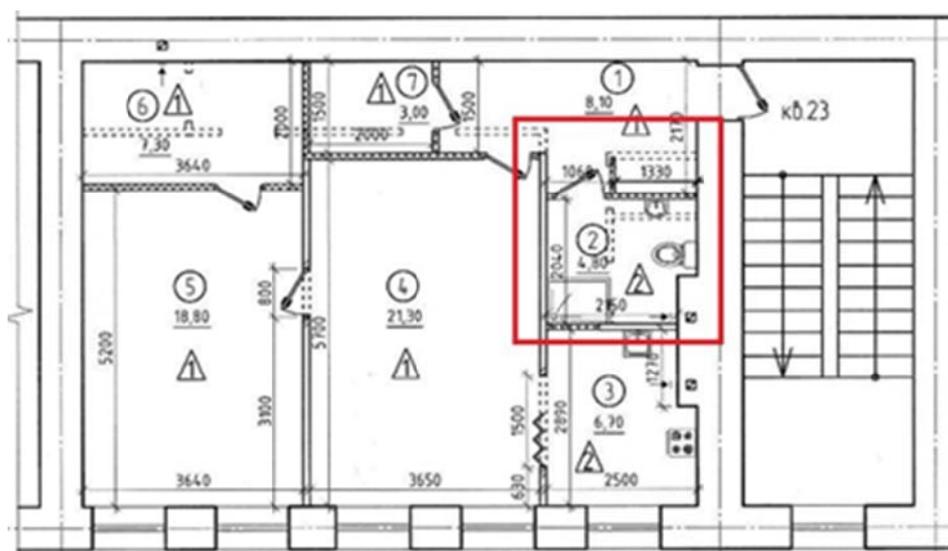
Пример монтажа и демонтажа перегородок и дверных проёмов на плане помещения
